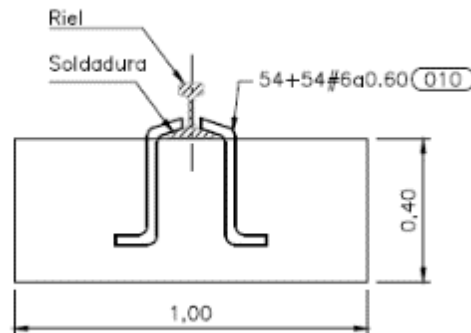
Vista en alzado de la estructura de cimentación de una grúa pórtico de 16 t (unidad: m)
